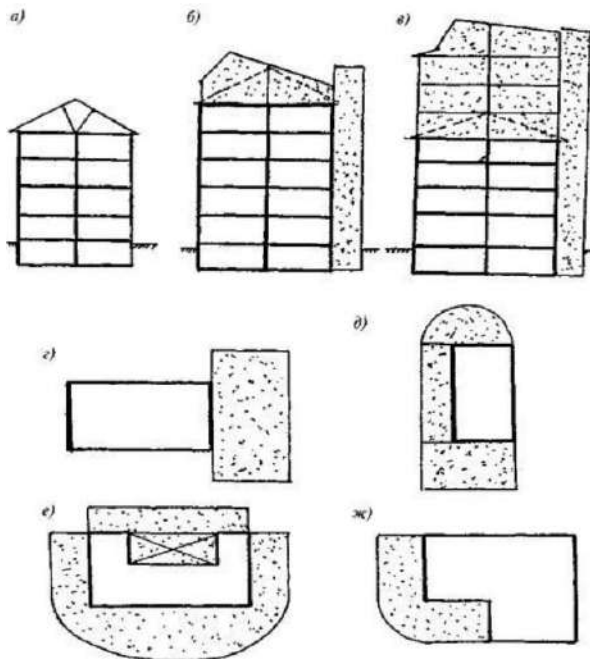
Варианты реконструкции жилых зданий ранней постройки:
